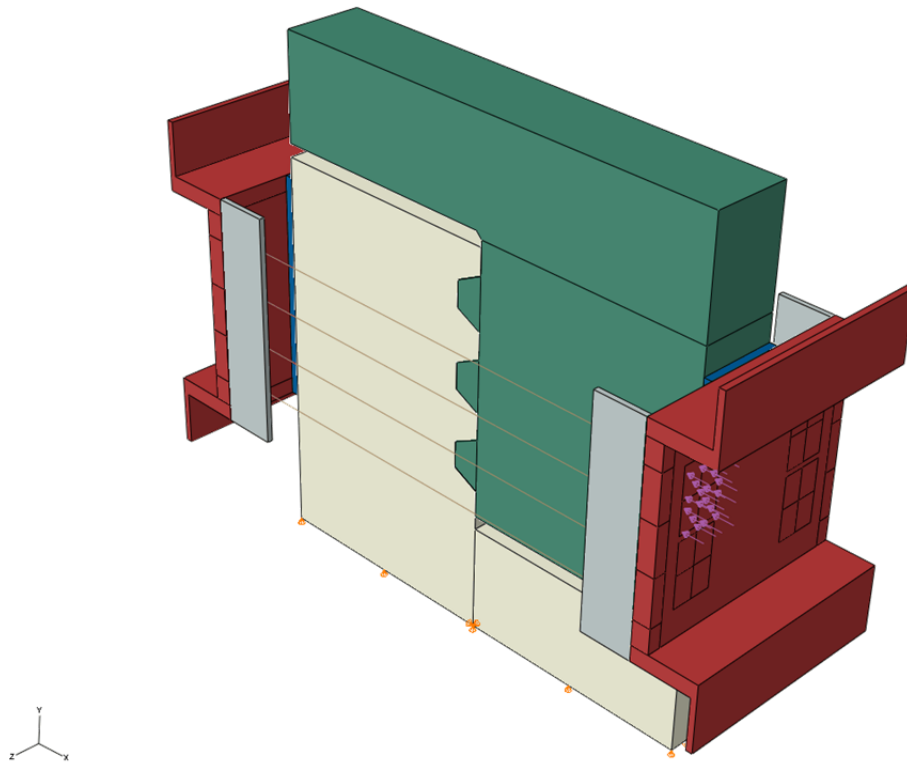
Modelo del ensayo de la junta de tres llaves y elementos auxiliares, reforzado con la platabanda de 20 mm, plancha de neopreno y pestañas de 10 mm, para el caso de tesado de un solo cable
